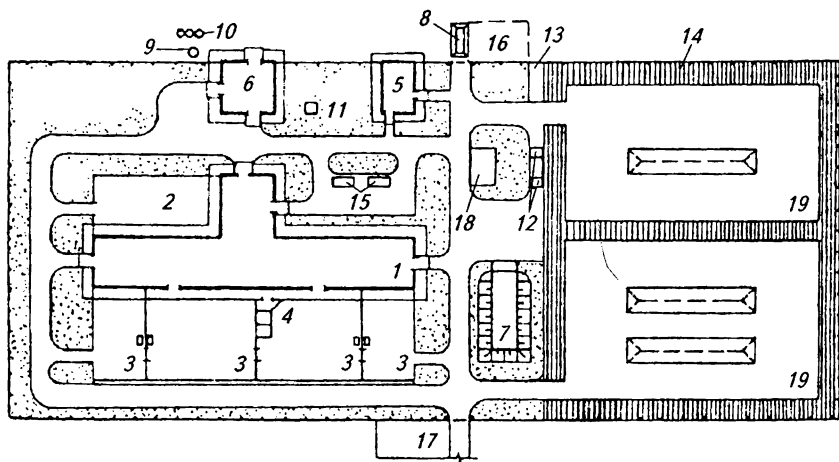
Генеральный план кумысной фермы на 50 кобыл:
